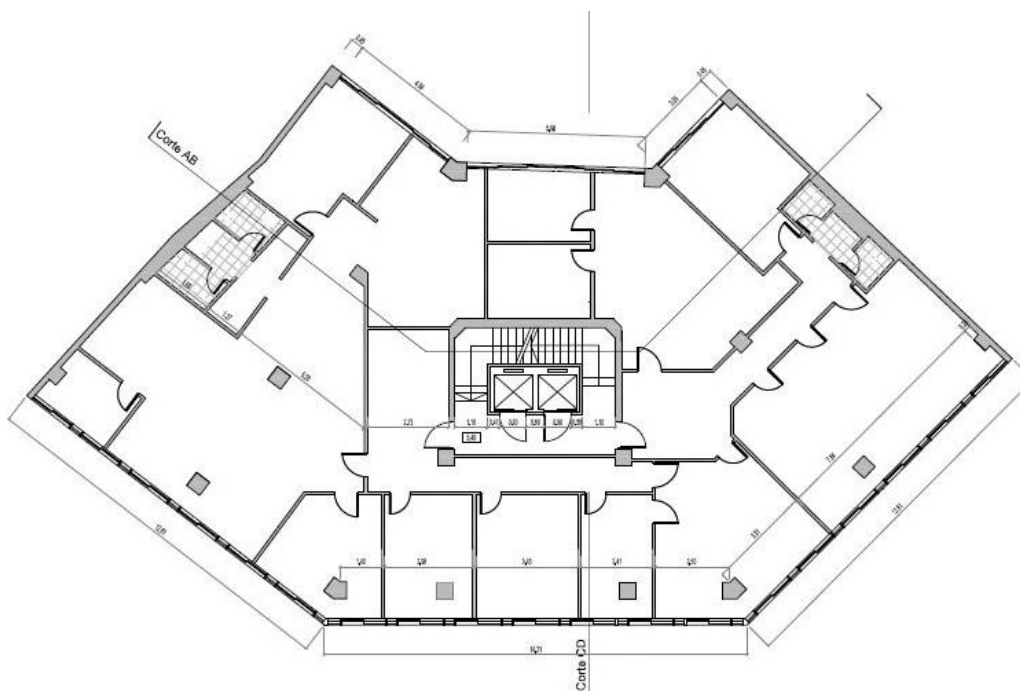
Planta do levantamento arquitetônico dos pisos compreendidos entre o 0 e 6º pisos
